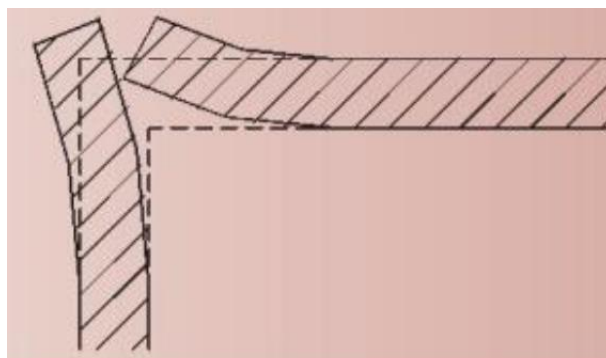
Deformação devida à falta de junta de movimento ou armadura
